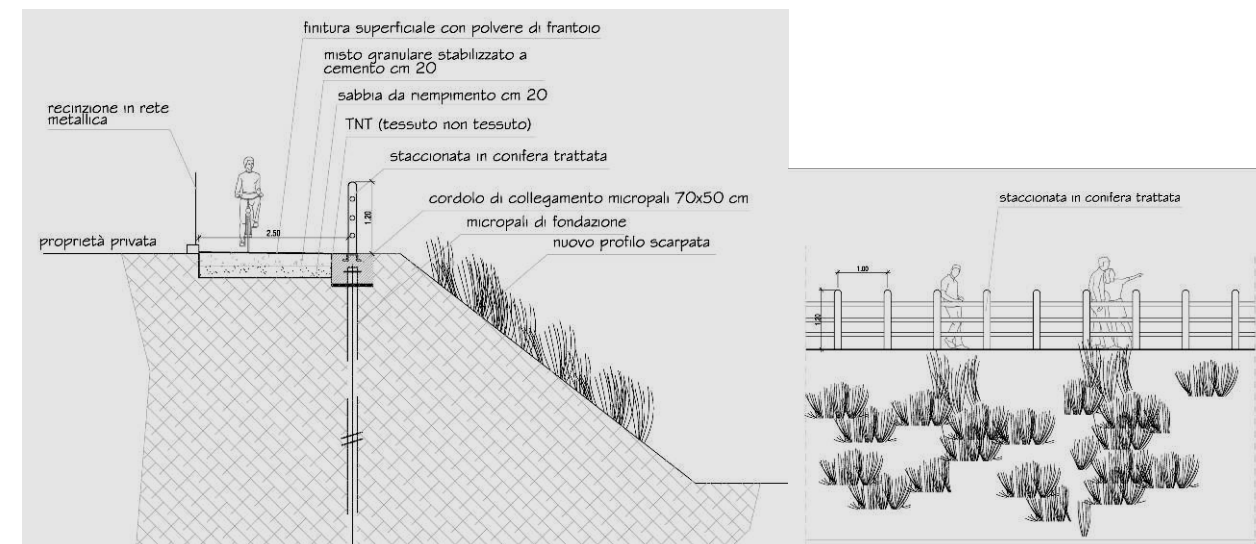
Sezione e prospetto tipo ciclovía tratto in corrispondenza proprietà Casali – Realizzazione staccionata su pali micropali
